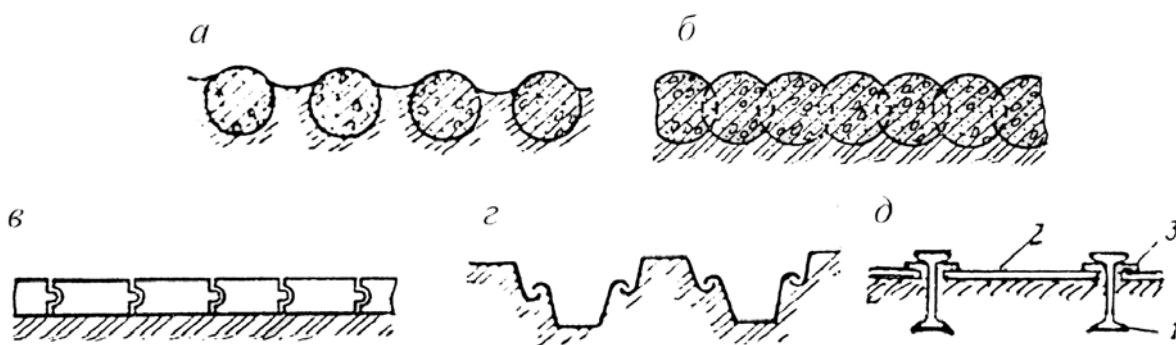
Ограждающие конструкции стен (котлованов):
